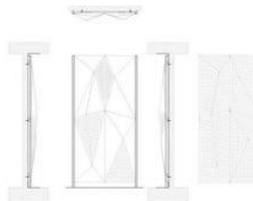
Elevación y sección- Paneles geta. Fuente: Archidaily
